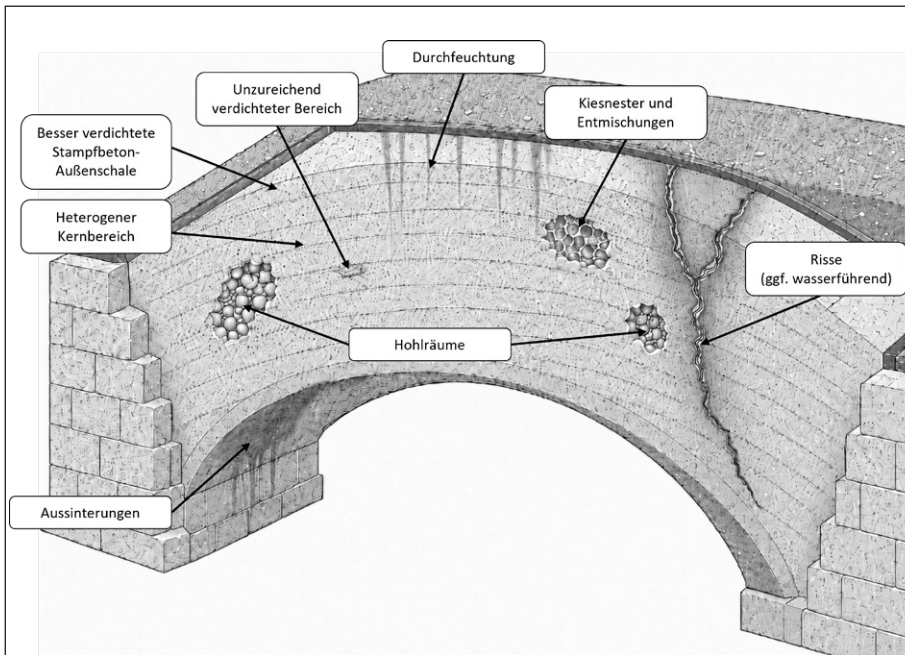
Schematische Darstellung typischer Schadensmechanismen und -bilder bei Stampfbeton-Gewölbebrücken
